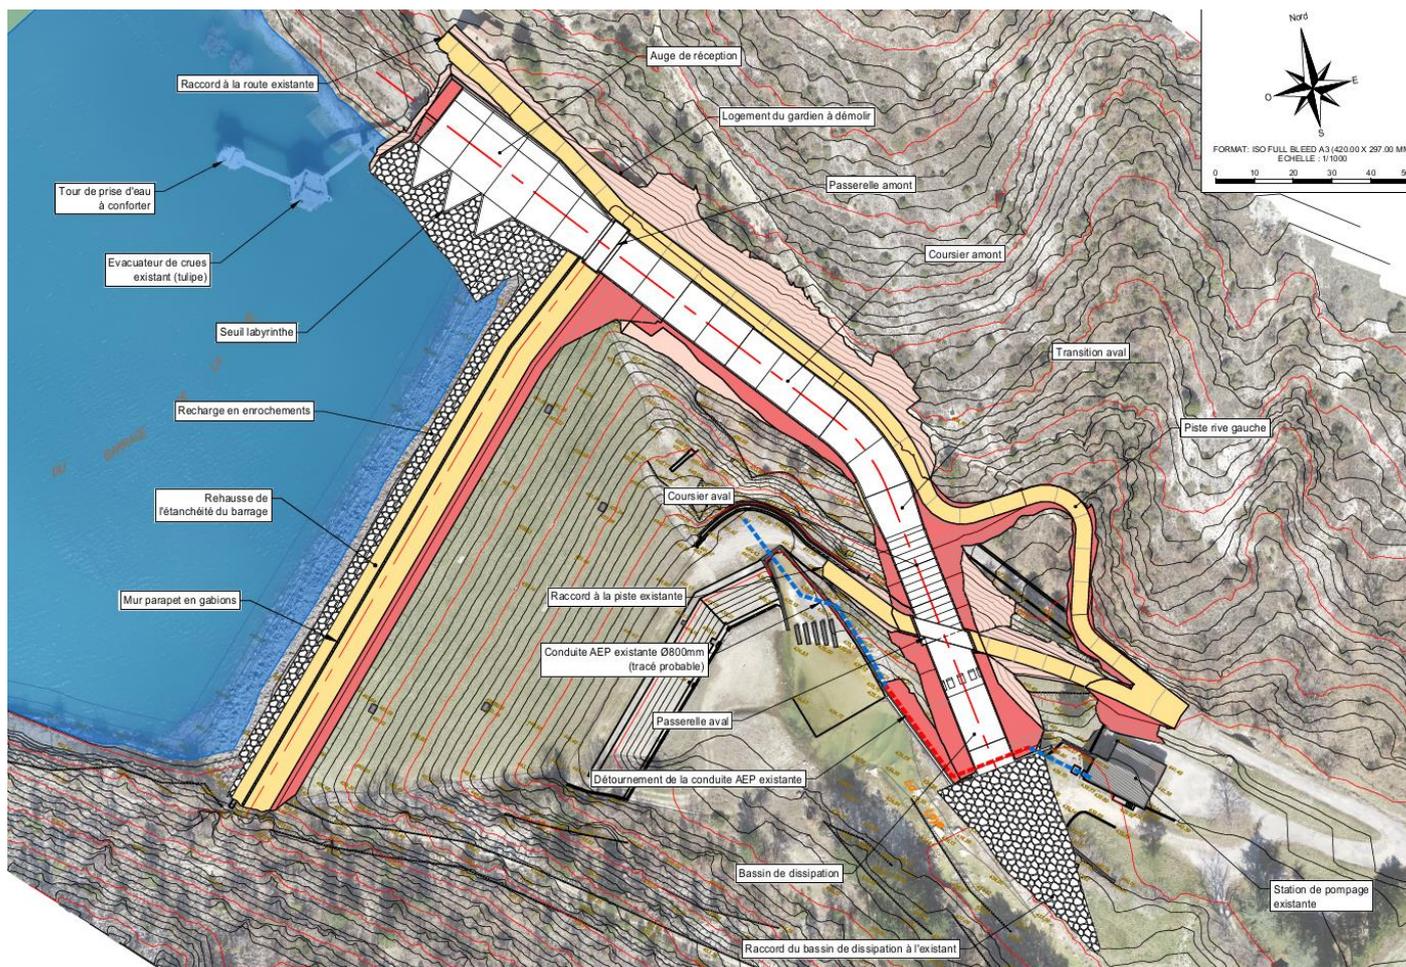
plan de masse des ouvrages projetés (source Artelia – avril 2022)
